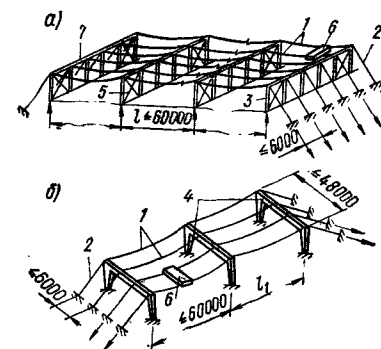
Схемы многопролетных одноярусных покрытий на прямоугольном плане
